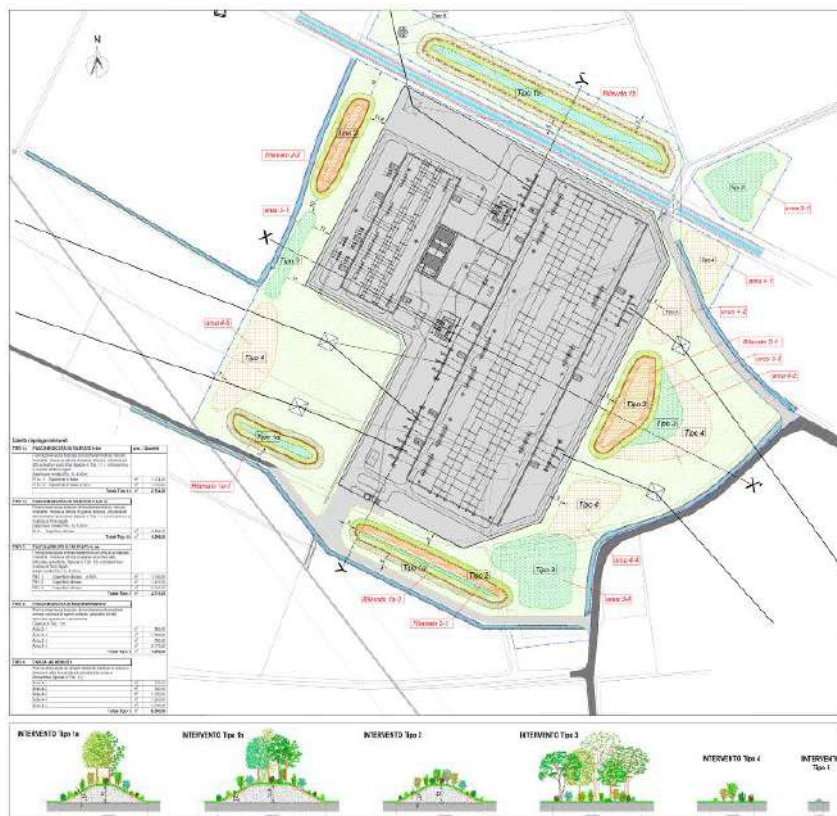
Planimetria e sezioni tipo di interventi di mascheramento e rivegetazione della nuova Stazione Elettrica di Maleo (LO) (Progetto esecutivo Terna Spa)
